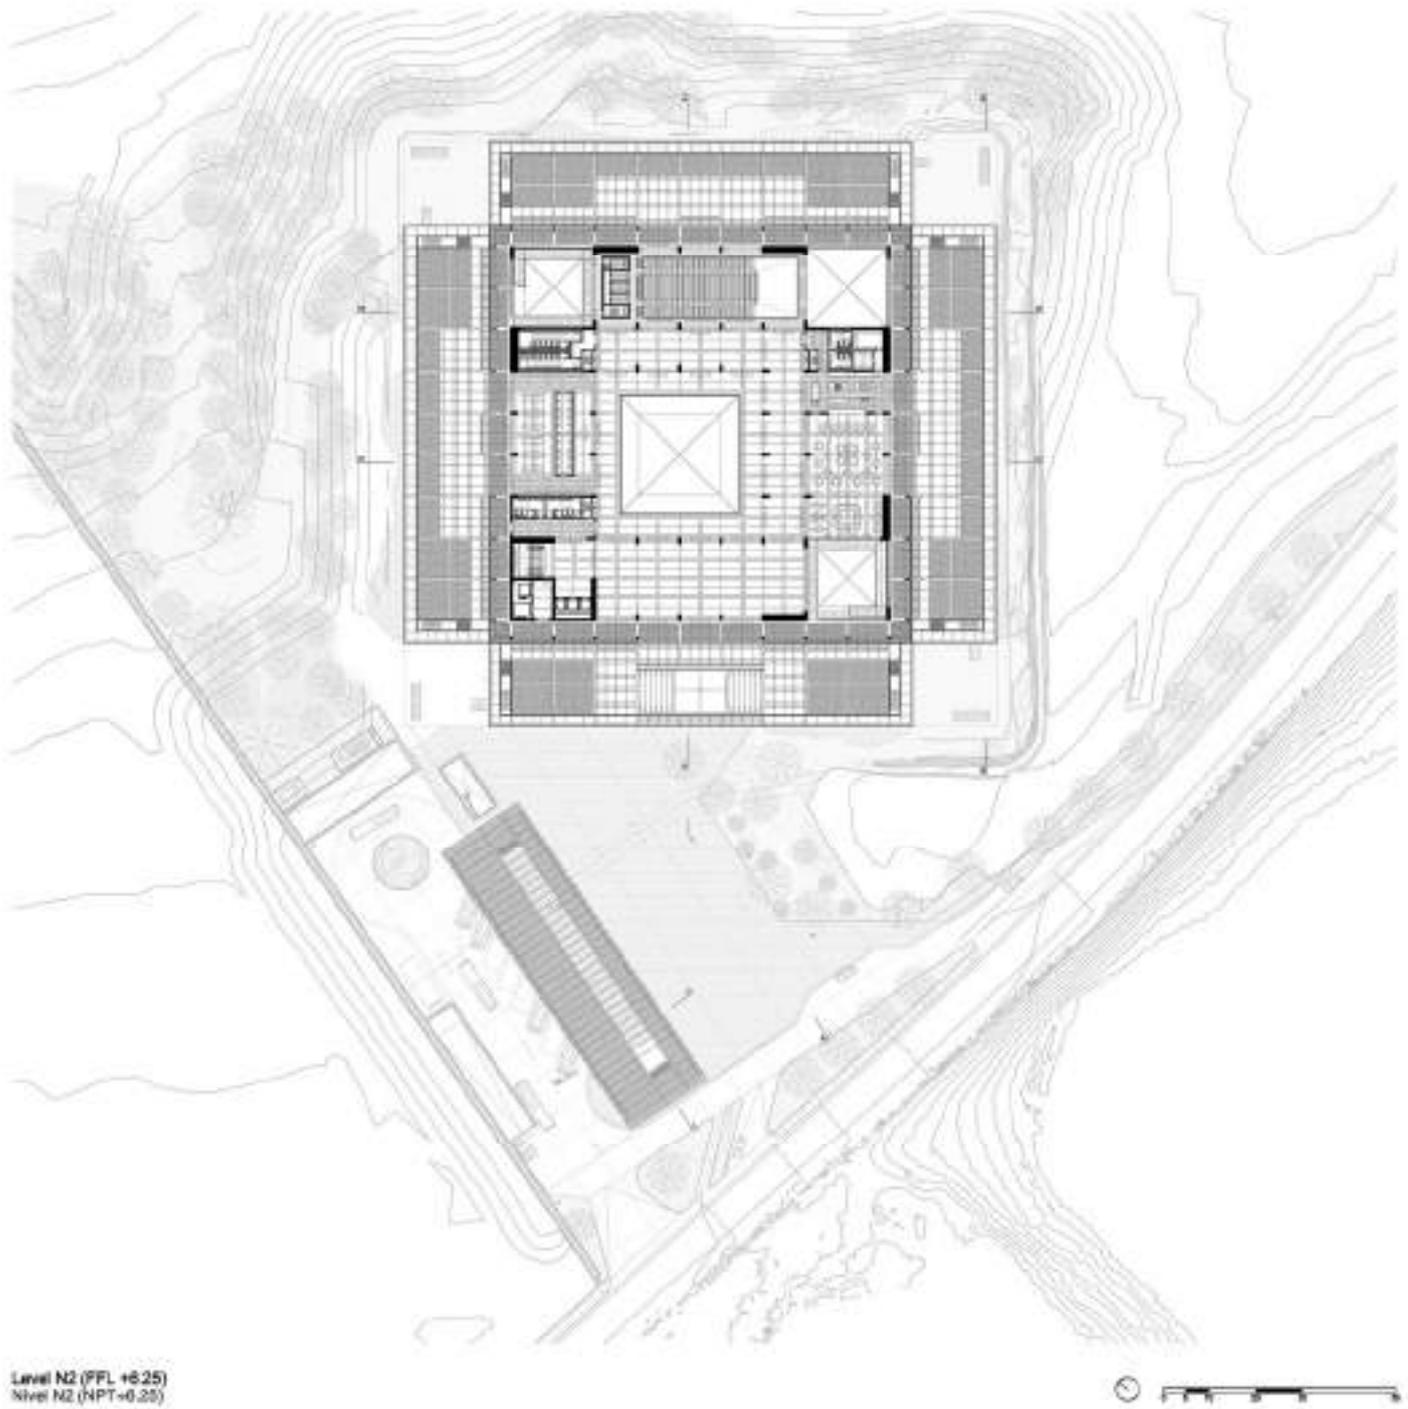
Museo Nacional del Perú. Planta nivel +2. Fuente: leonmarcial arquitectos
